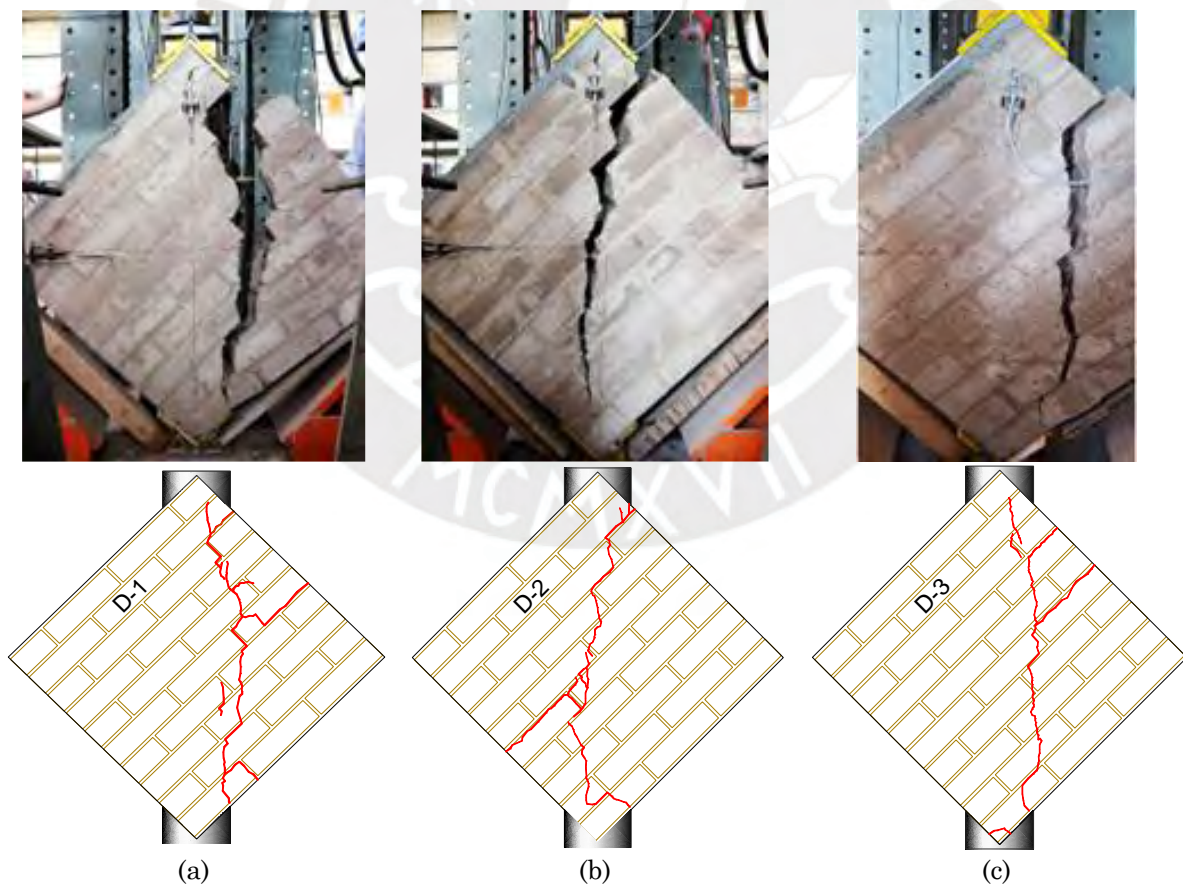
Mecanismos de falla: (a) murete D-1, (b) murete D-2, y (c) murete D-3.
